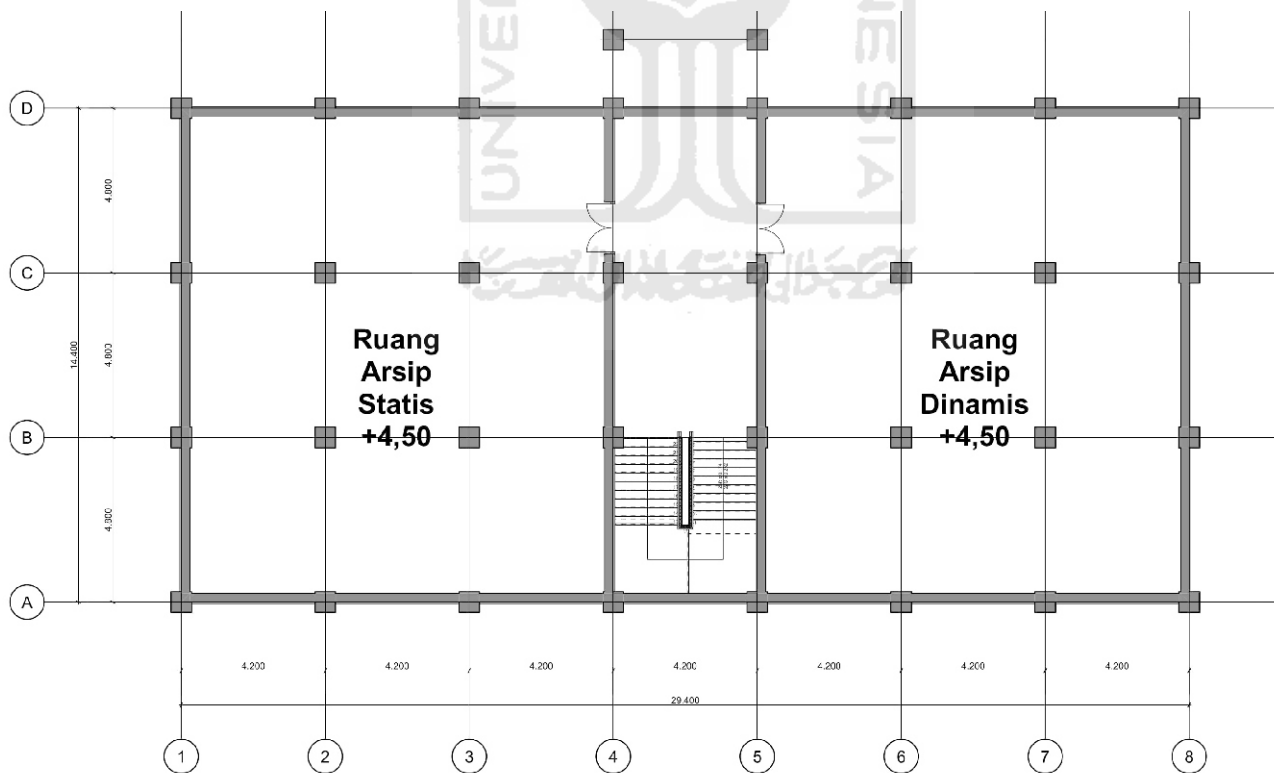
Denah Bangunan Perpustakaan sebelum dan sesudah
